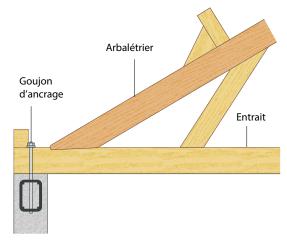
Exemple d'ancrage de la charpente dans le béton par goujon d'ancrage
